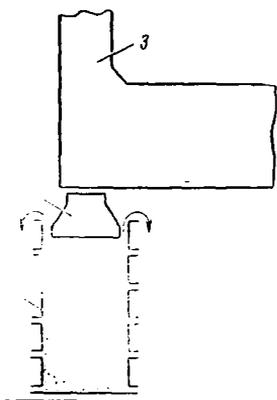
Размещение песочницы для опускания пролетного строения
